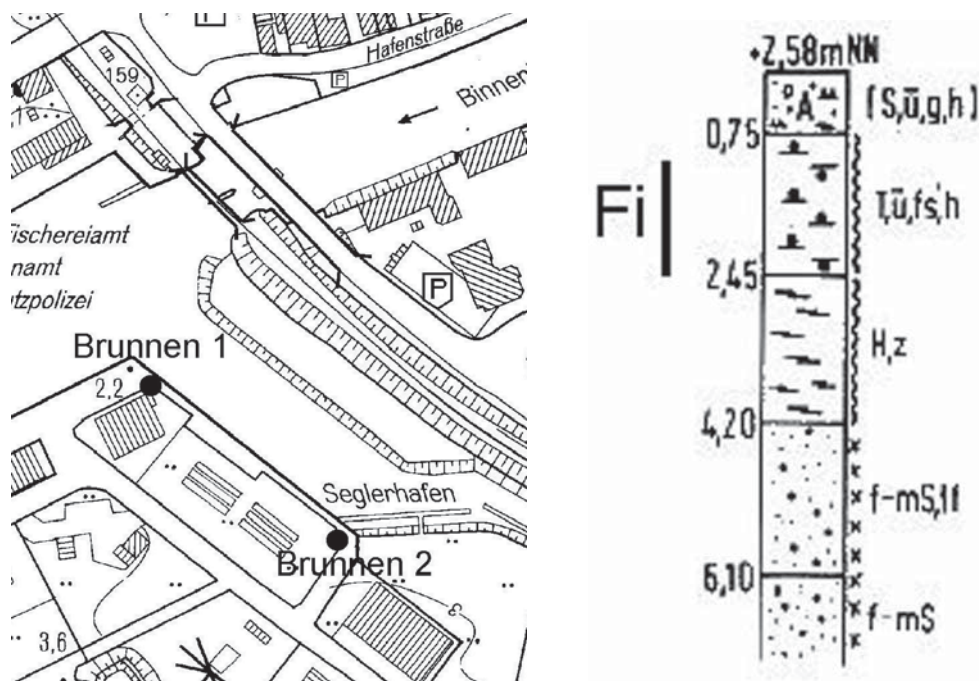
Lageplan mit Bohrprofil an der Fischereikaje Husum
